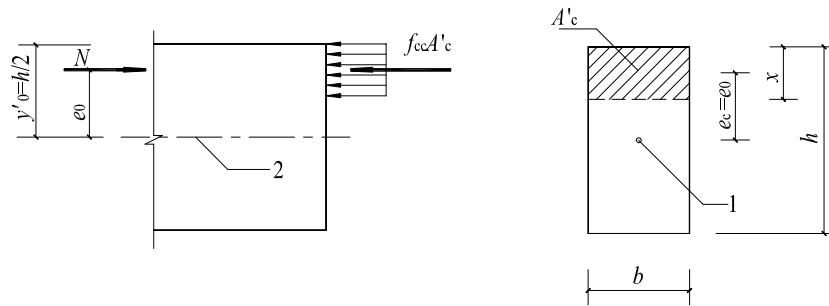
矩形截面的素混凝土受压构件受压承载力计算
